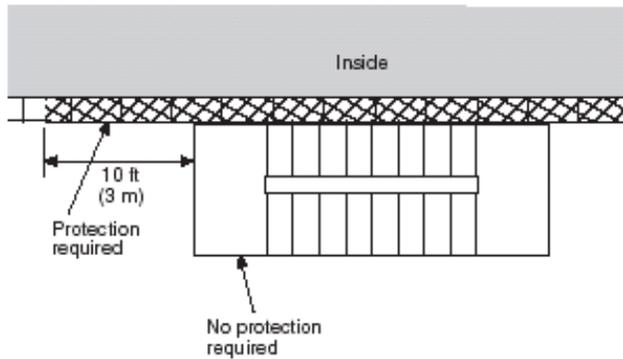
CAJA ESCALERA CON UN MURO INTERIOR
